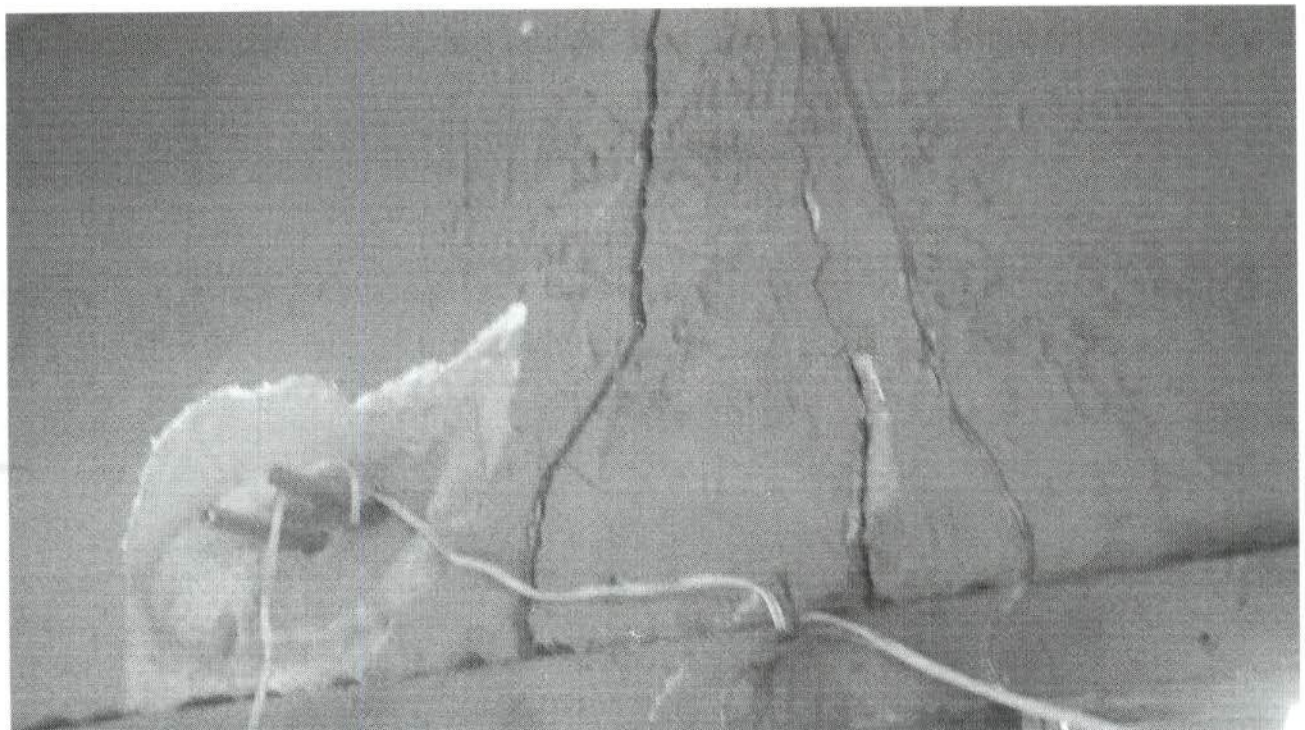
Rachaduras na parede de salão de beleza localizado na rua Sebastião Gomes.
